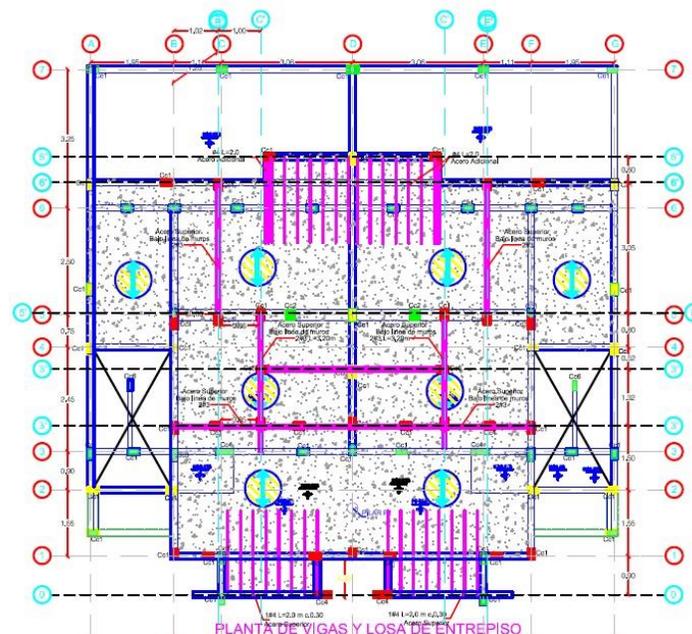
Planta de Losa y Vigas de Entrepiso. Fuente Diseño Ing. Carlos Ariel Hurtado.
